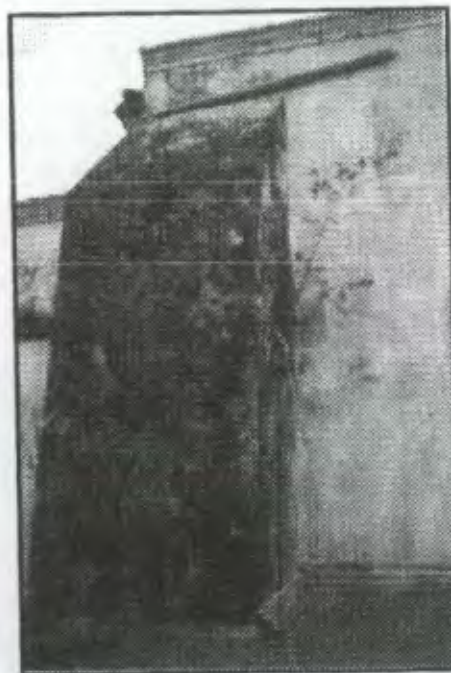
Se puede observar la unión de la lamina y el muro. La presencia de macroflora, las instalaciones expuestas alterando la estructura así como hongos, manchas, entre otros.
